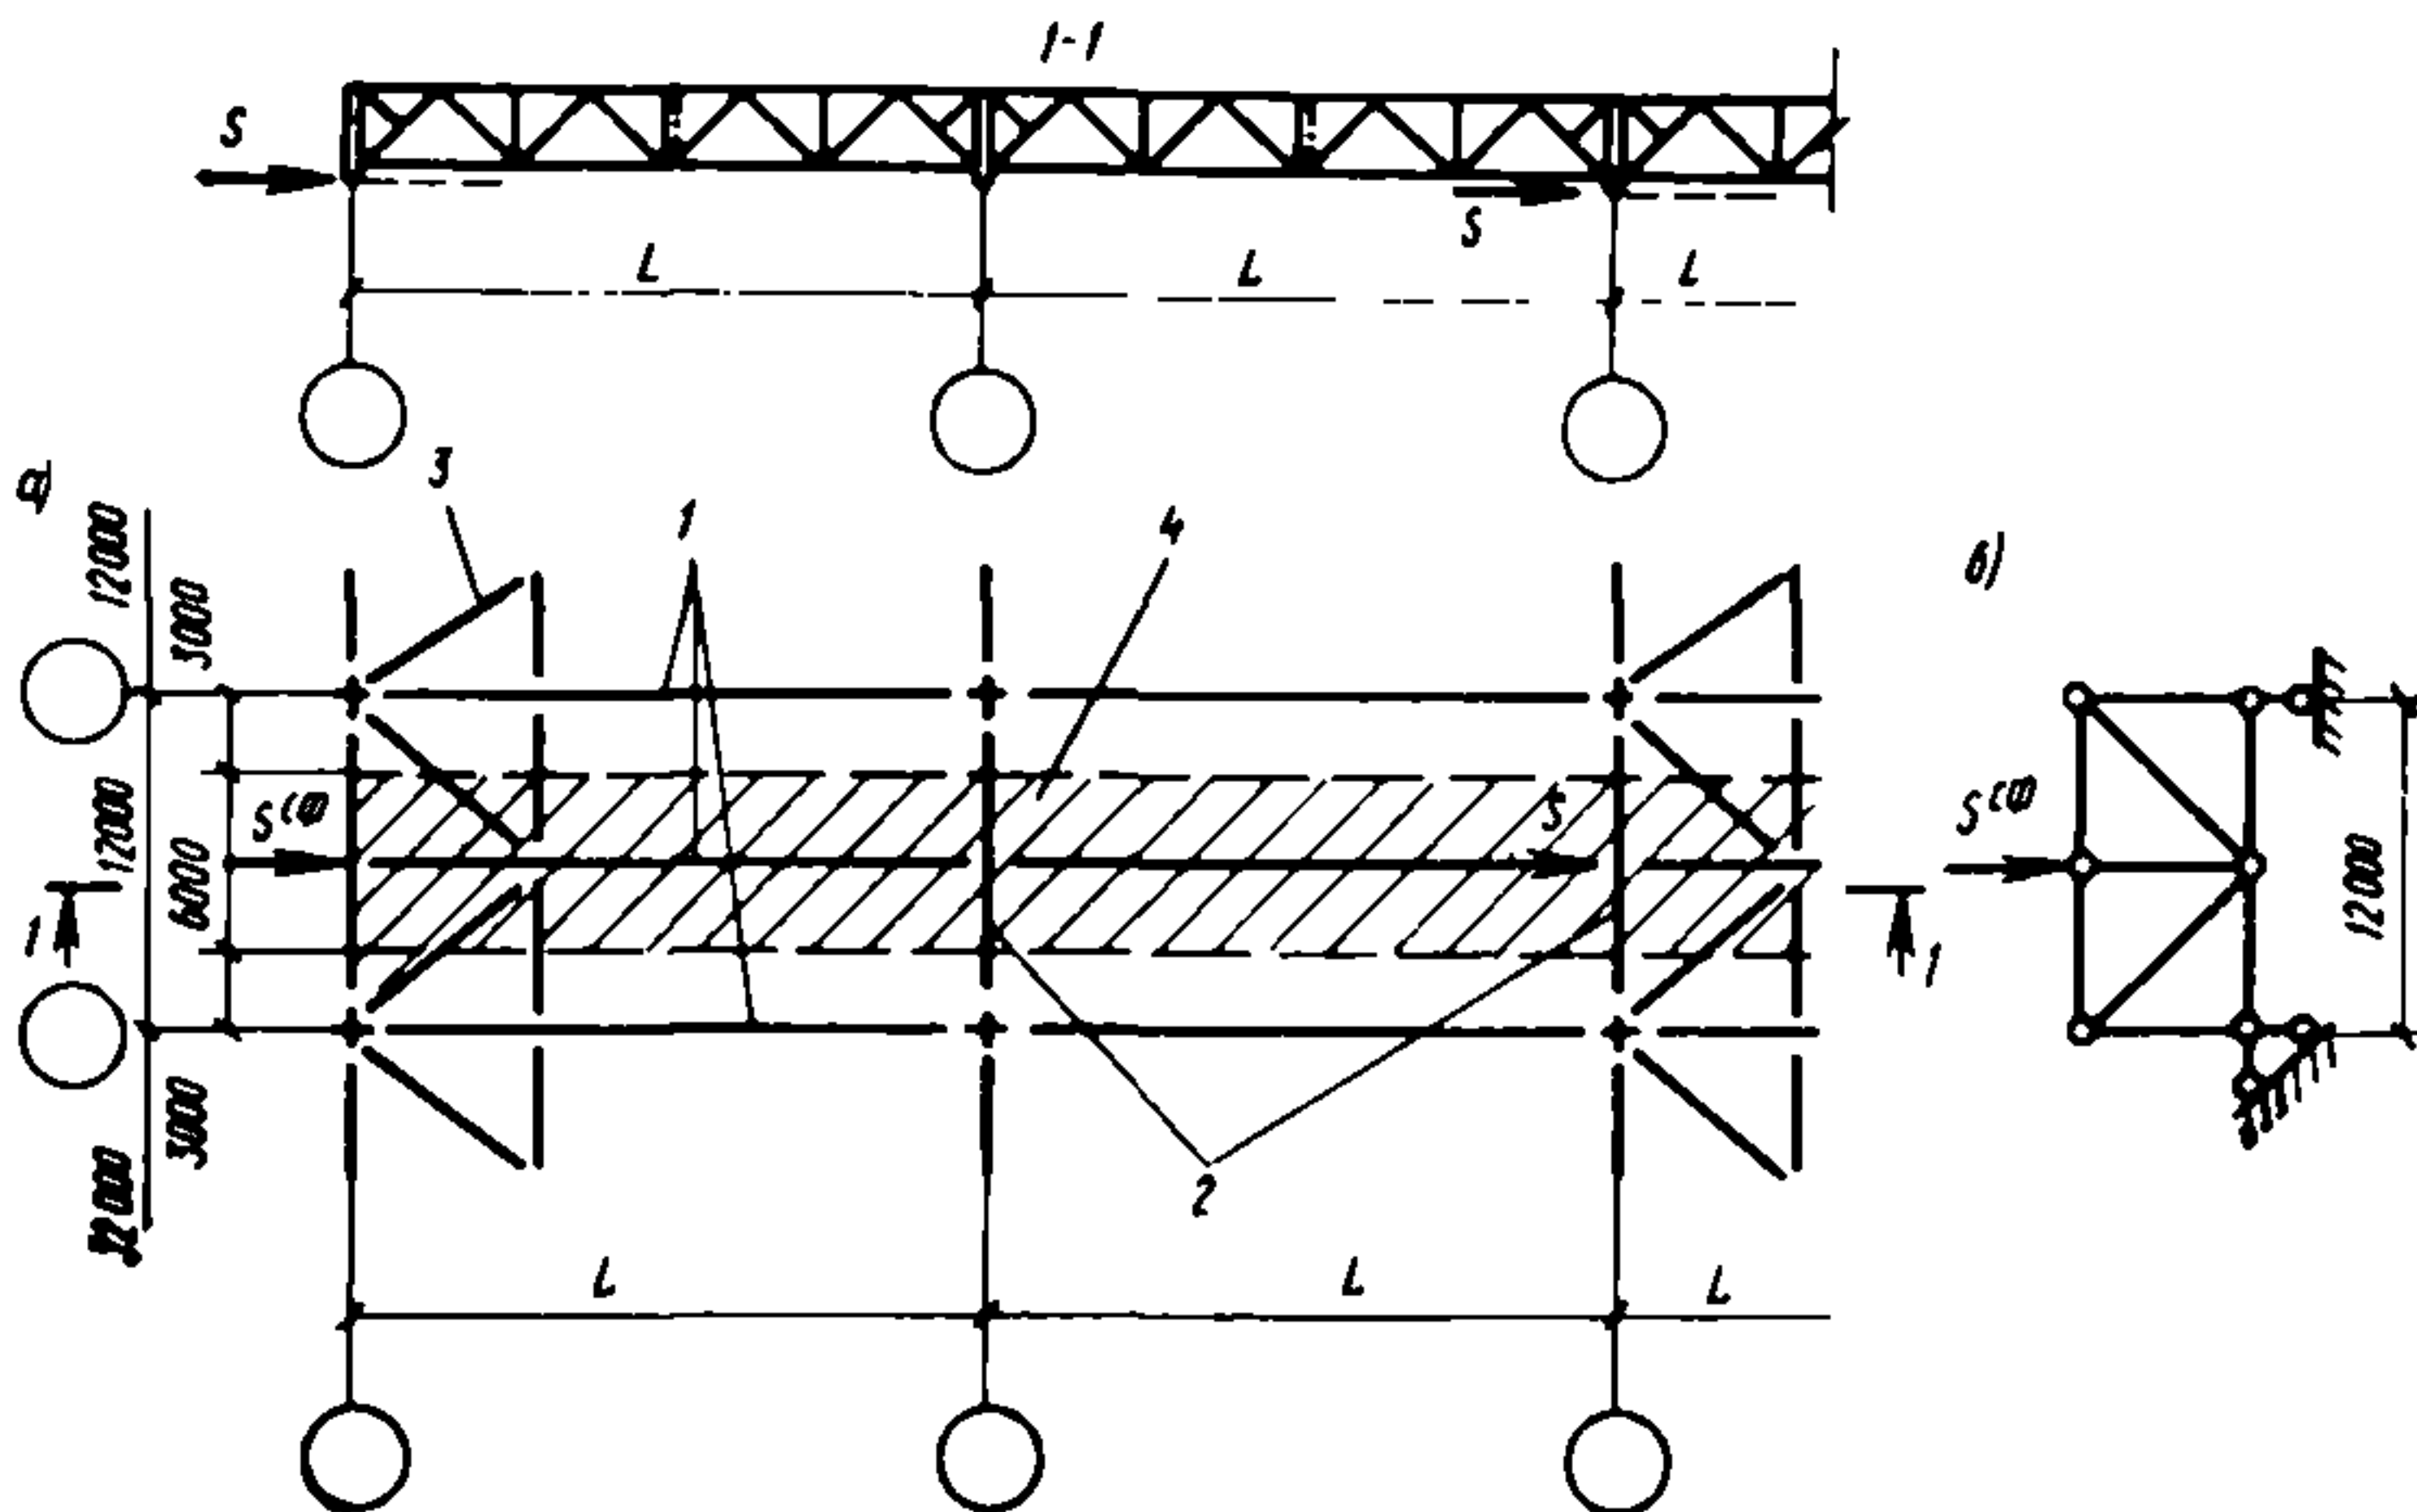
Схемы к расчету продольных связей по нижним поясам стропильных ферм в покрытиях с подстропильными фермами
